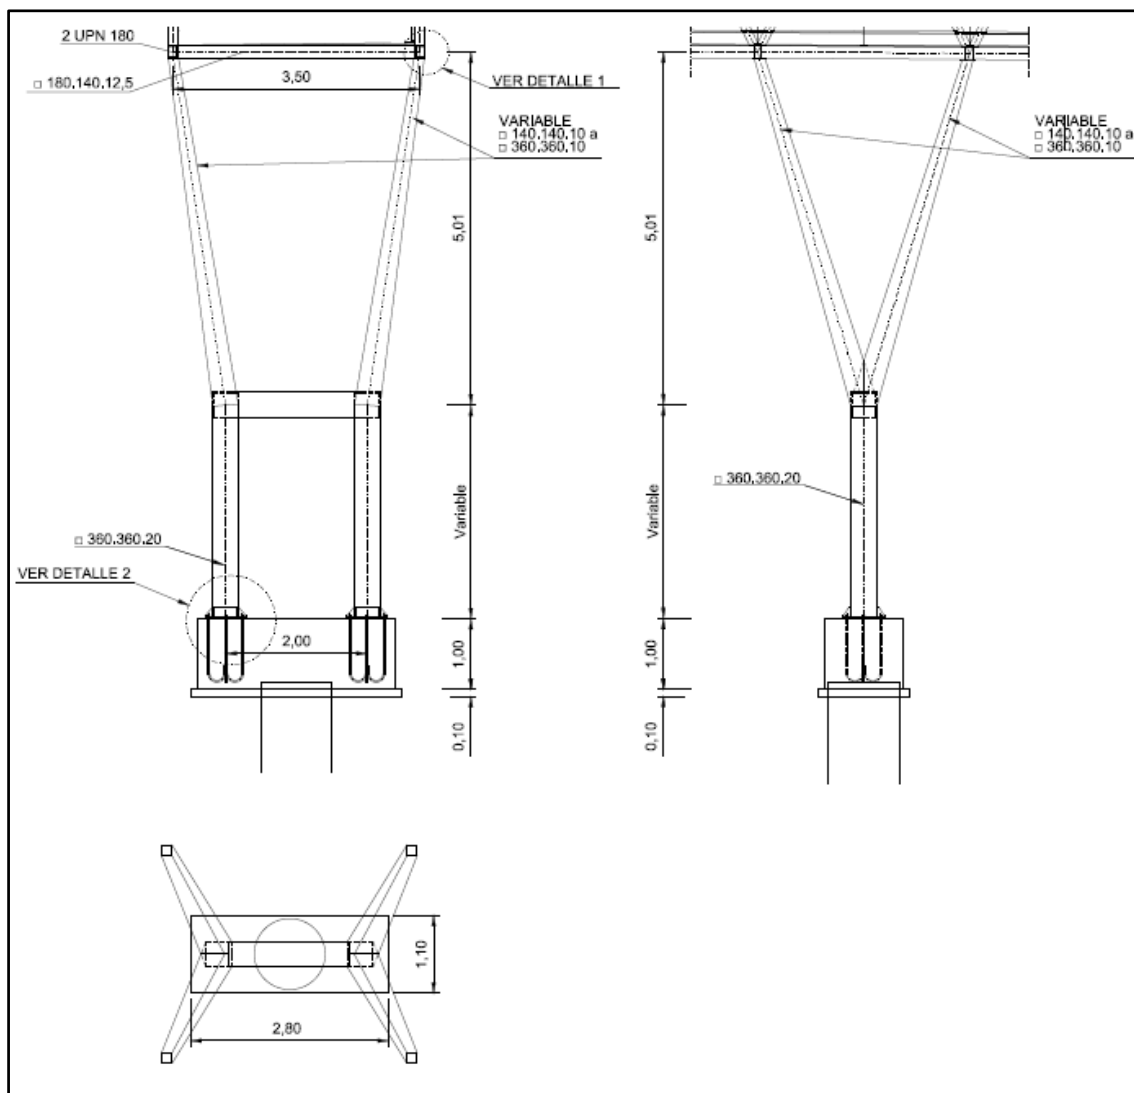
Alzado, planta y perfil de las pilas. Fuente: Documentación gráfica cortesía de Acciona.
